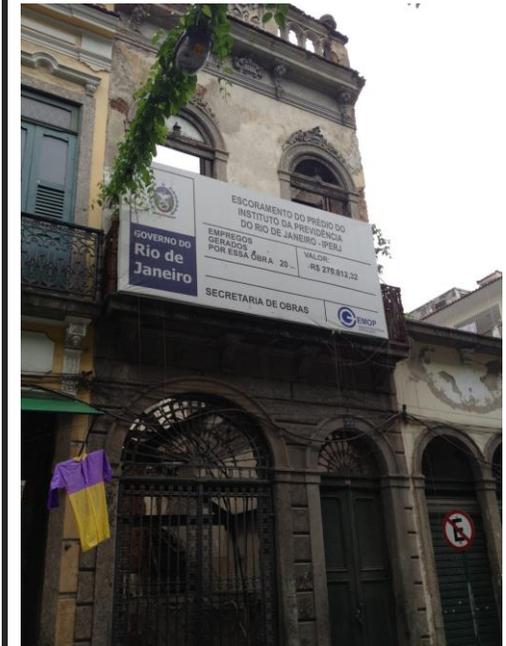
Fachada do sobrado. Fonte: Paula Peret. Data: 01/2013.
